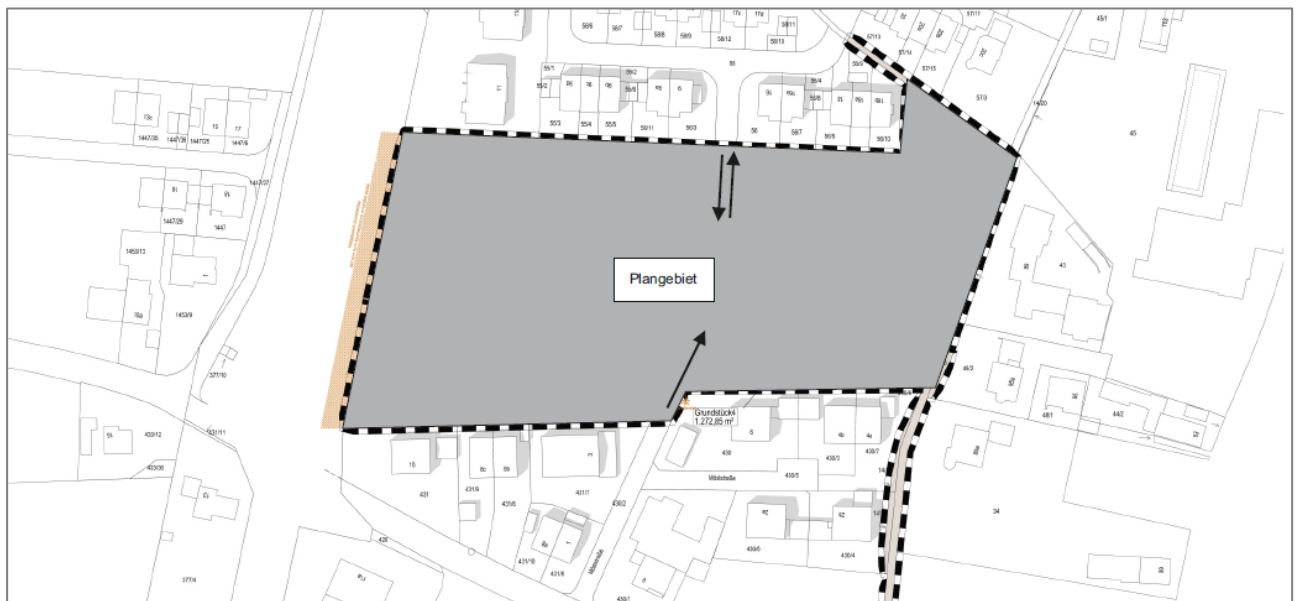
Erschließungsvariante III, Plangrundlage: Planungsgruppe Strasser
